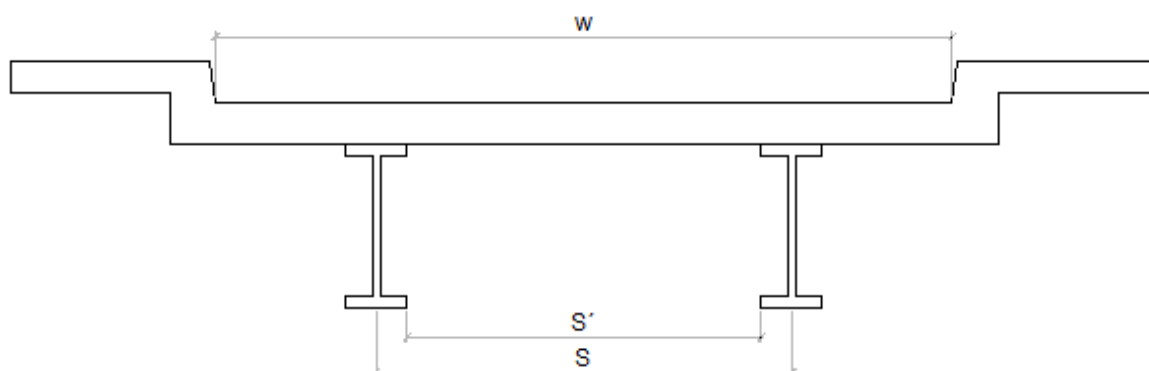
Sección transversal Viga Sección Compuesta. Fuente: Elaboración propia.
